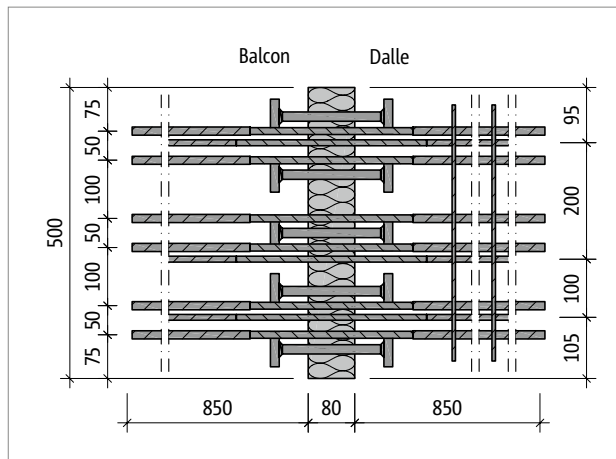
Schöck Isokorb® T Type K-M12-V1 : Plan de base du produit
